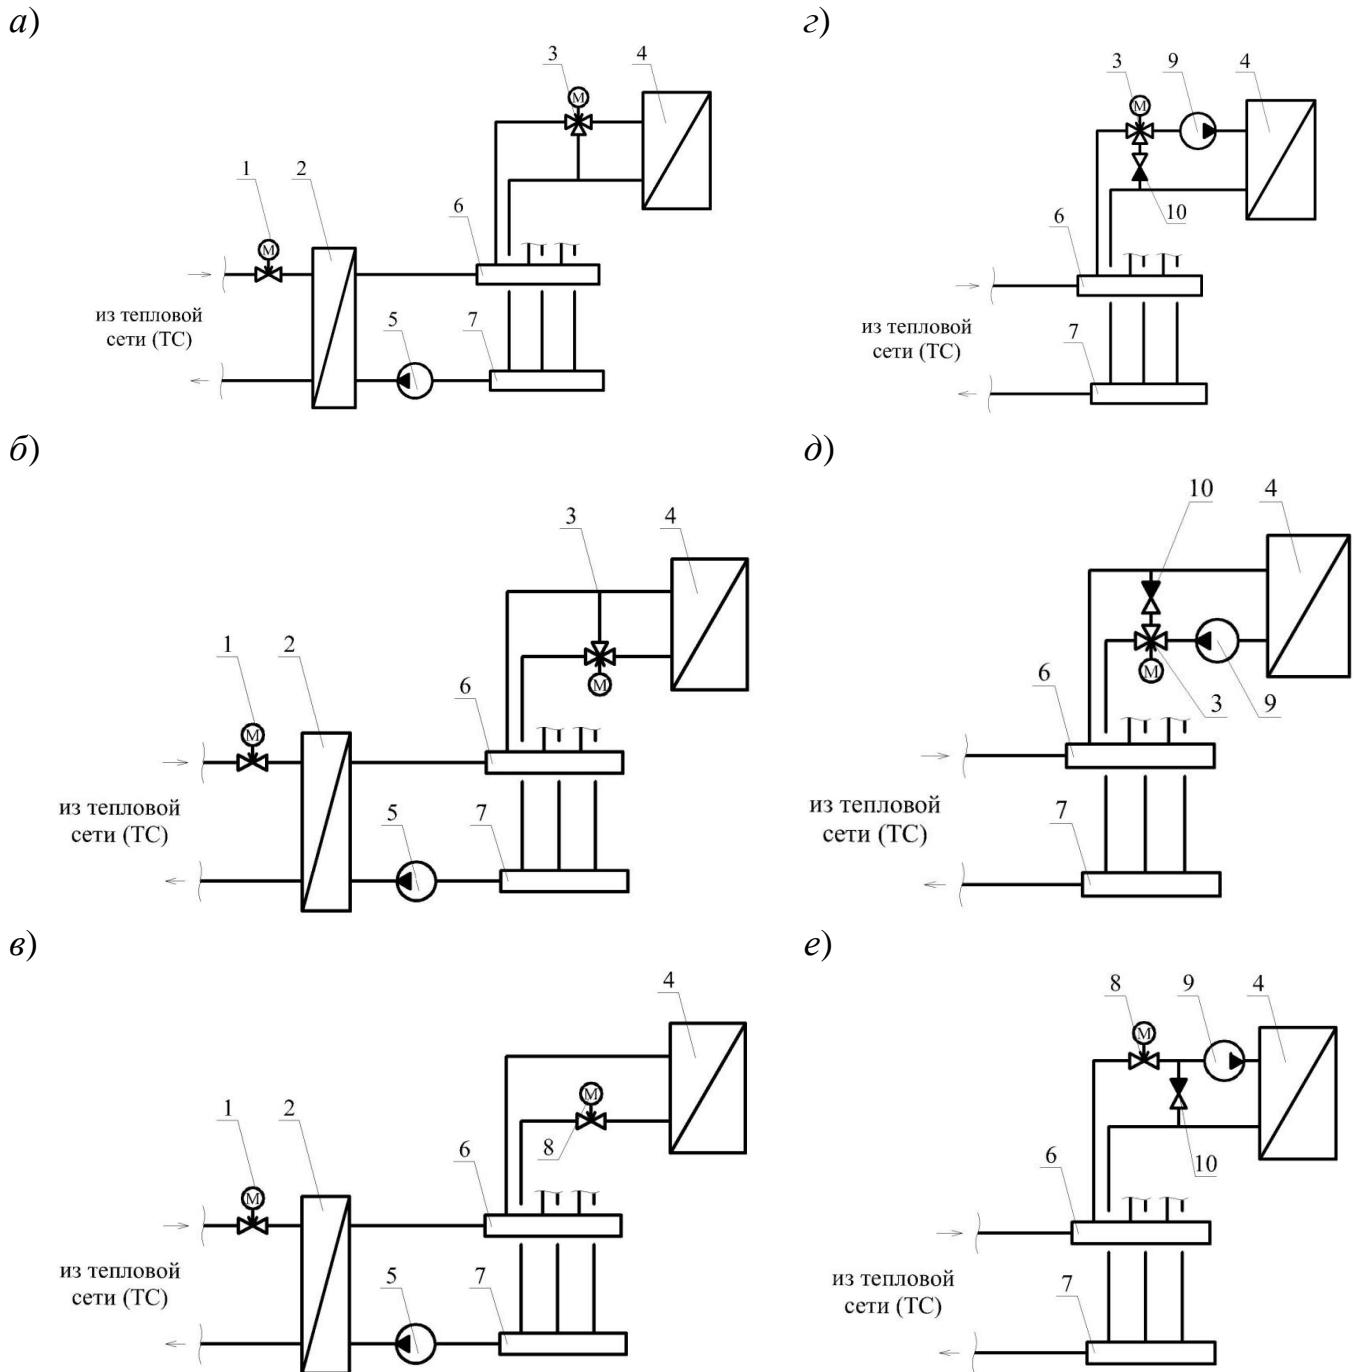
Схемы подключения системы внутреннего теплоснабжения вентиляционных установок к тепловой сети:
